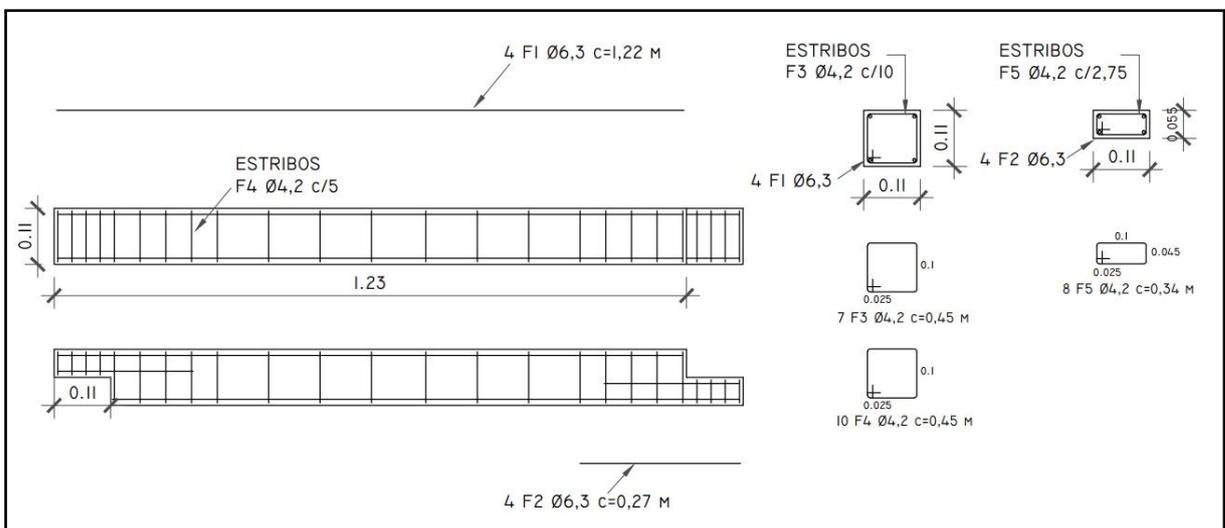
Detalhamento da armadura da placa B (11x101x52)
